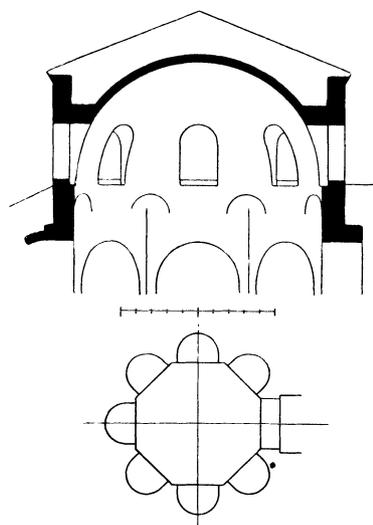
Kuppel von S. Vitale in Ravenna. Schnitt 1:500. Grundriß 1:1000.
